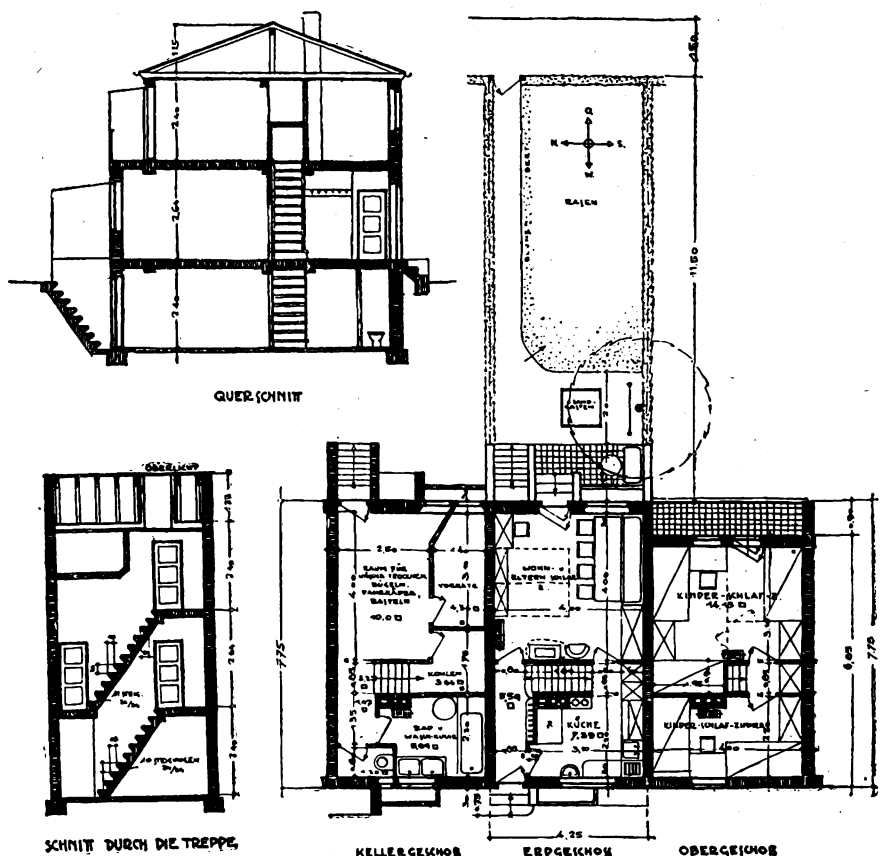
4. Einfamilien-Reihenhaus mit 7½bettiger Wohnung.
